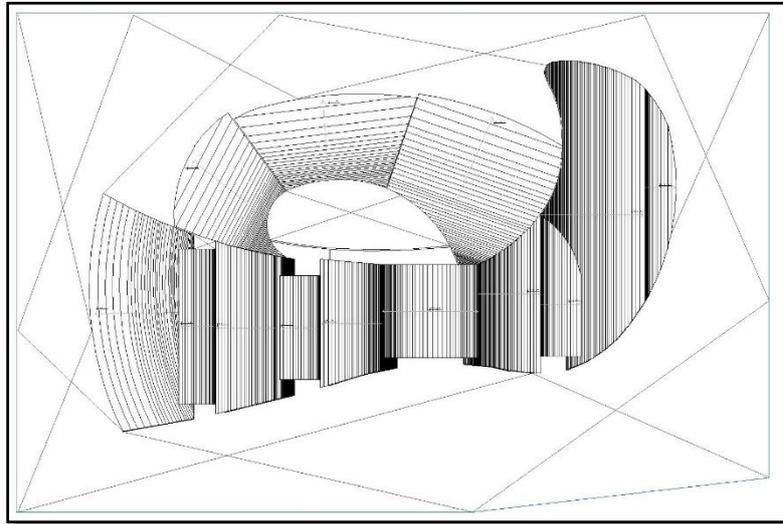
Plano de Techos /Fuente: Elaboración propia.
